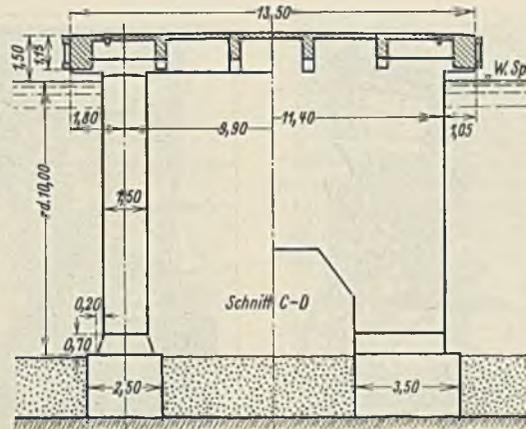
Kaianlage bei Wallvik. Querschnitt C-D.
